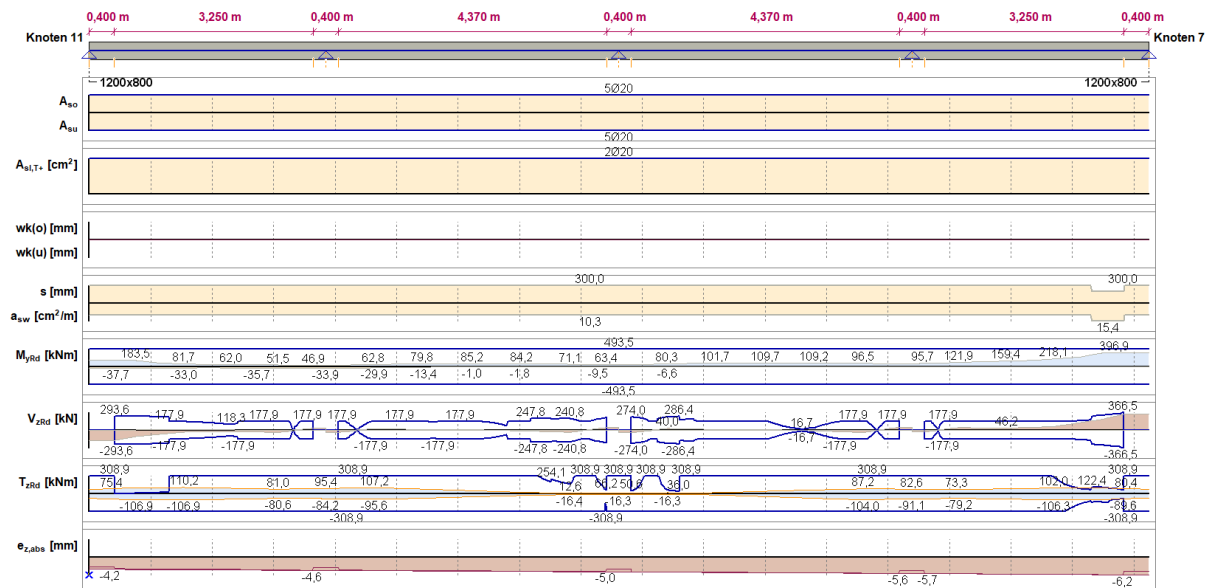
Berechnete Balkenbewehrung, Achse 4, vertikale Ebene
